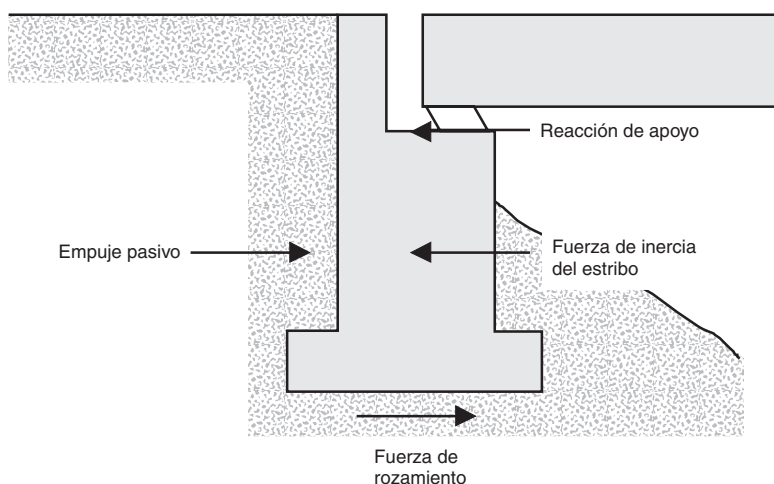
Equilibrio de fuerzas horizontales longitudinales cuando el tablero se mueve hacia el estribo
